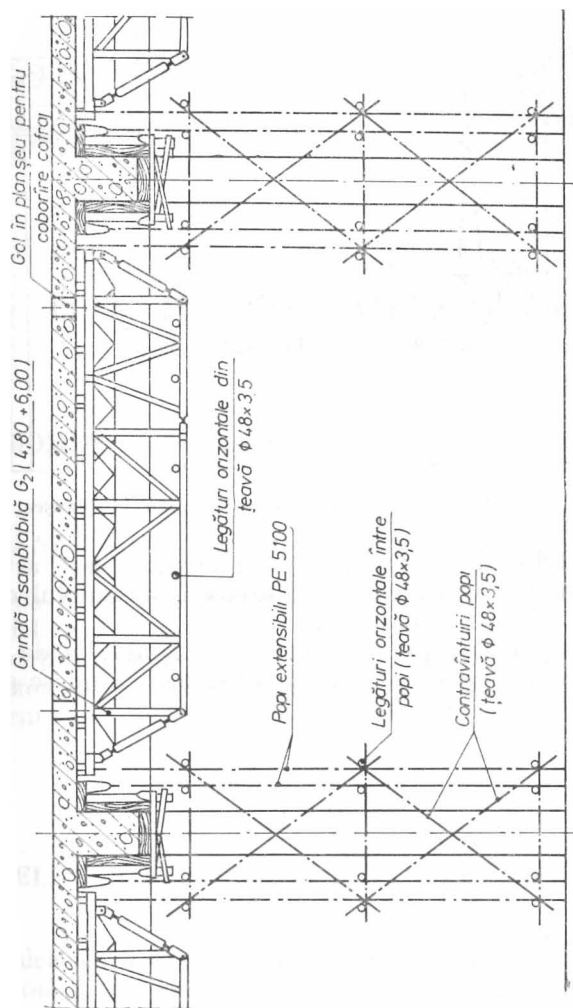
Montarea cofrajului mixt greu la planșee,
